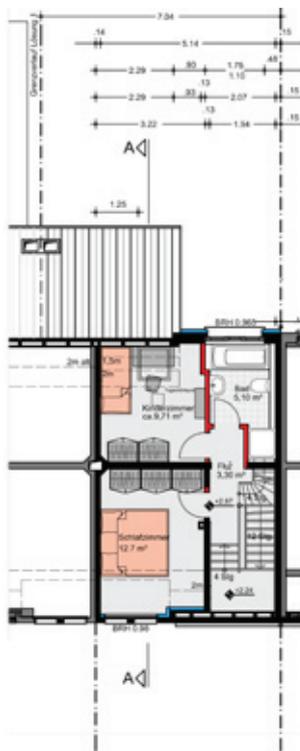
Grundriss 1. Obergeschoss Einzelhaus
